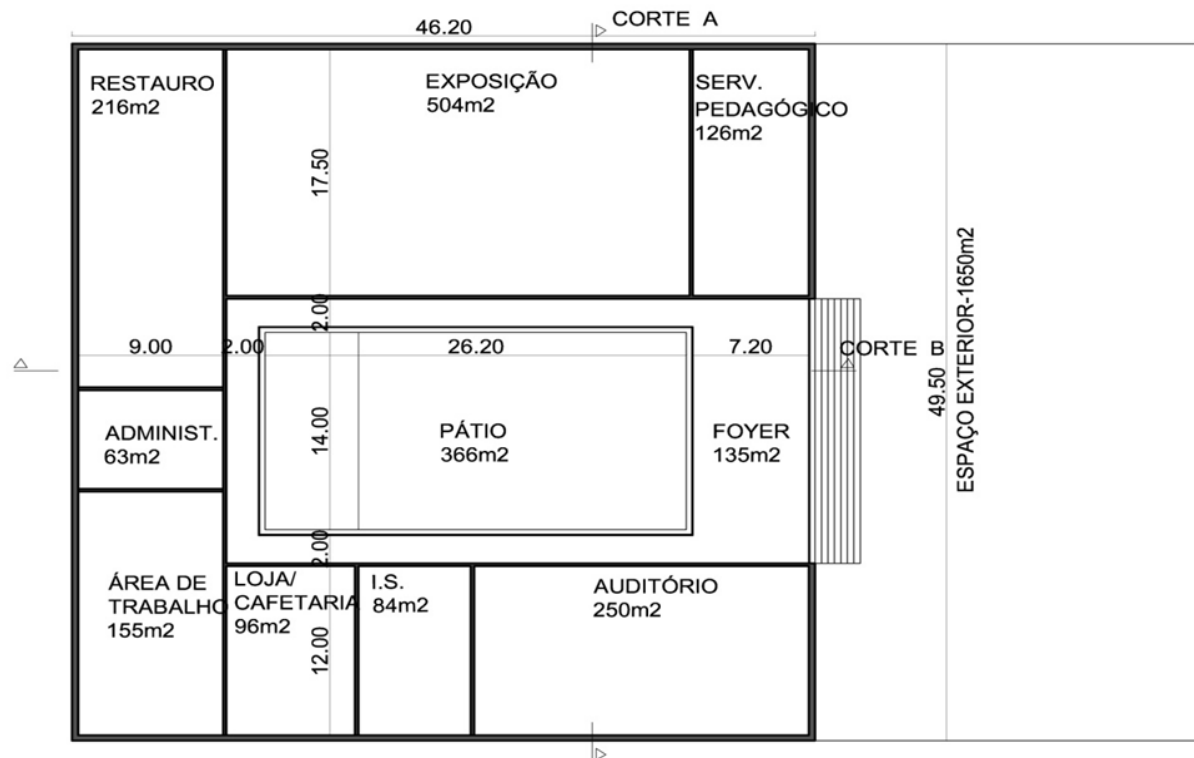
Planta do r/c. e espaço exterior onde localizamos as sondas horizontais
